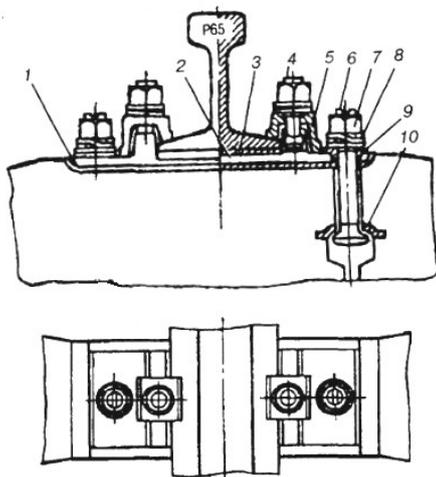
Конструкция рельсового крепления КБ-65: 1 – прокладка под подкладку; 2 – подкладка; 3 – подрельсовая прокладка; 4 – клеммный болт; 5 – жесткая клемма; 6 – закладной болт М22×160; 7 – гайка М22; 8 – двуххватковая
